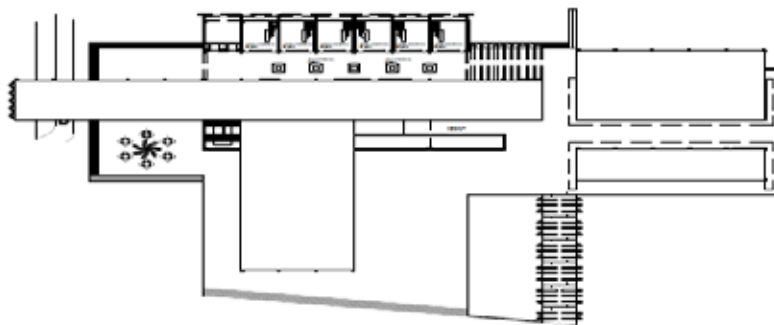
Segmentación por Volúmenes. Nave 1, Planta Baja. (2017)
